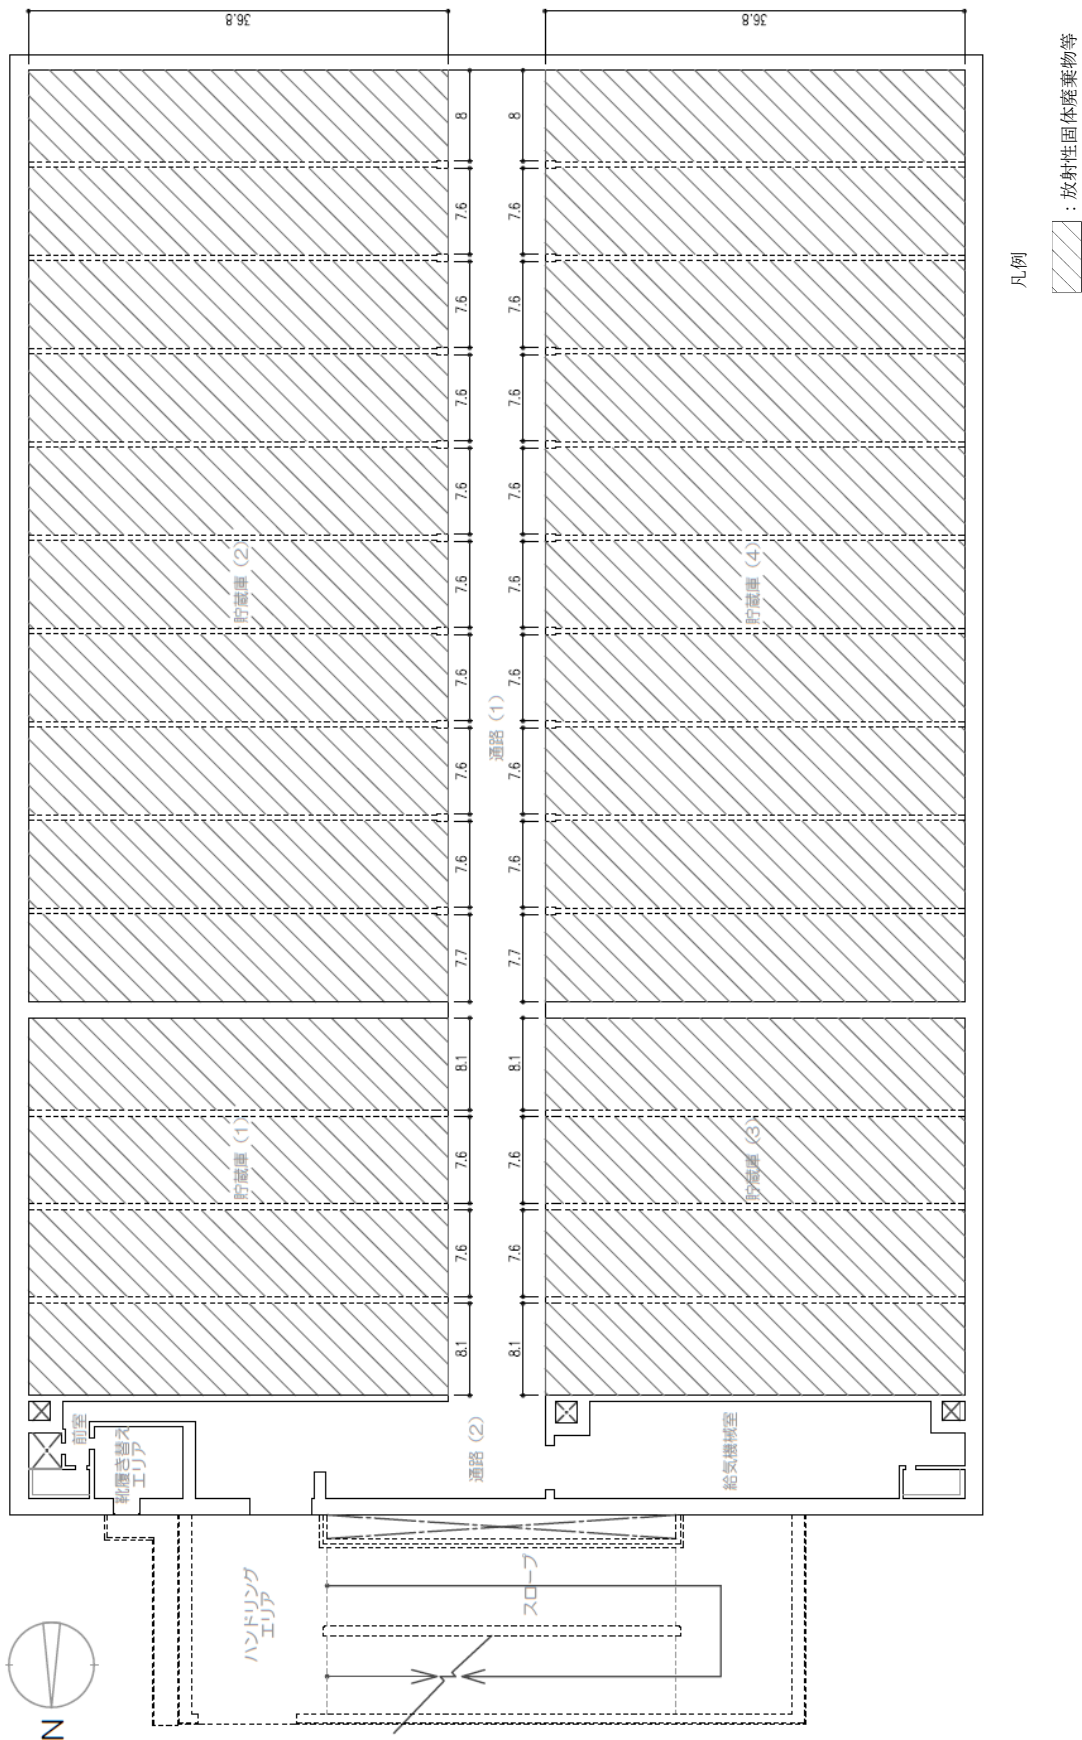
固体廃棄物貯蔵庫第111棟 1階 平面図 (単位: m)
